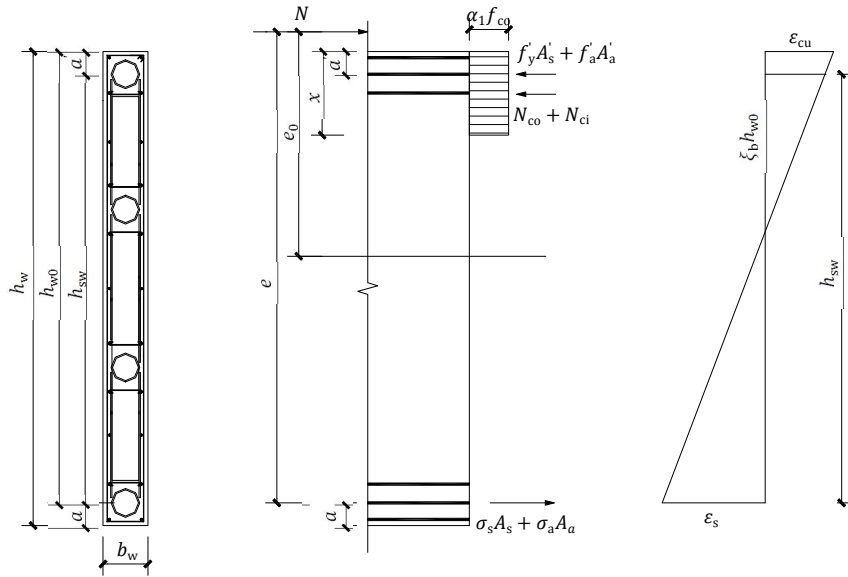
矩形截面偏心受压排钢管混凝土剪力墙正截面受压承载力计算示意图
